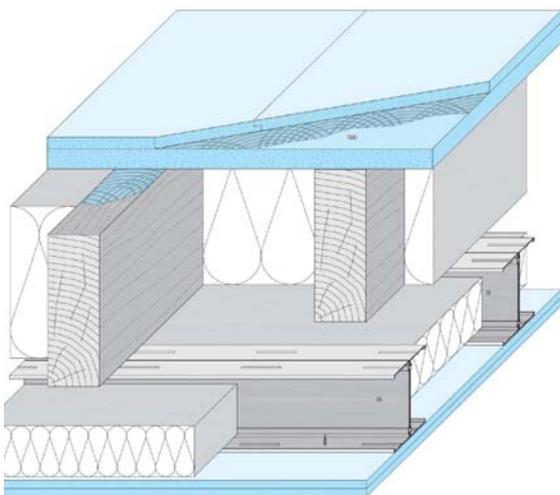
Konstruktion der Versuchsholzbalkendecke
